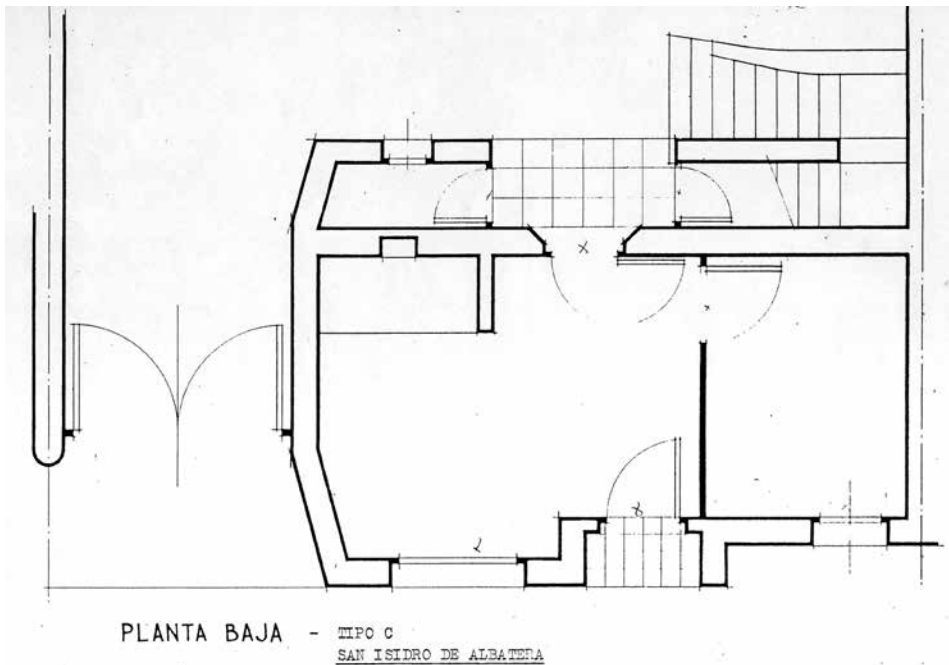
San Isidro, planta vivienda, tipo C, planta baja.
